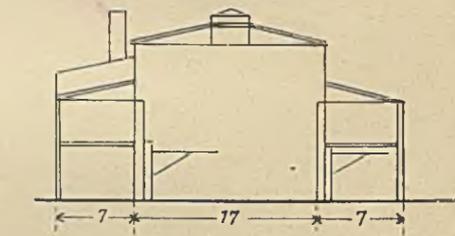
Gießerei der Chemnitzer Werkzeugmaschinen-
